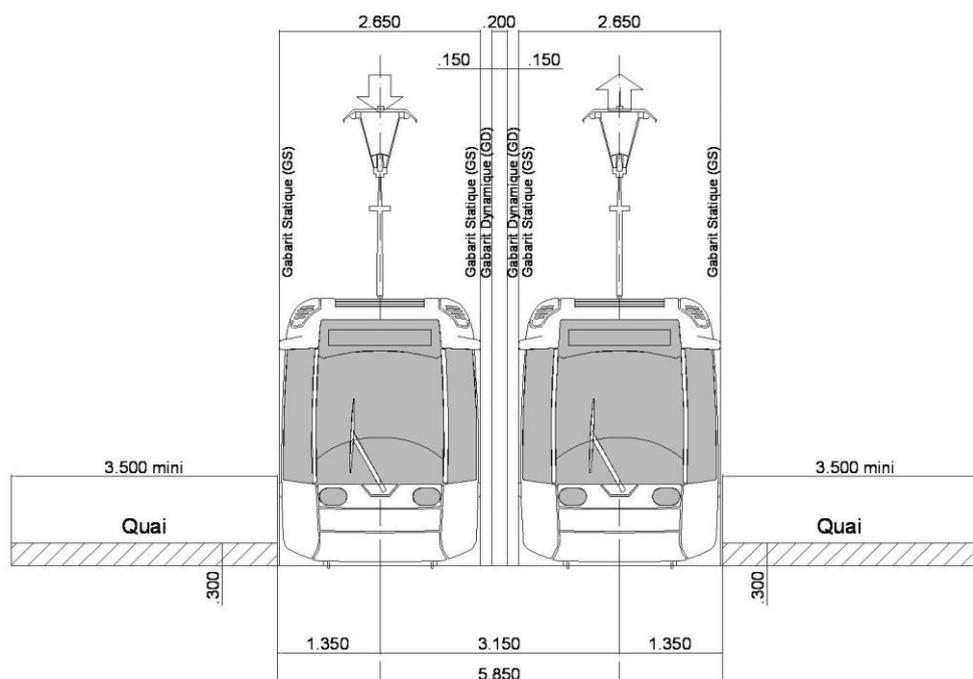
Coupe transversale du tramway en voie double, en station et avec poteaux latéraux.
